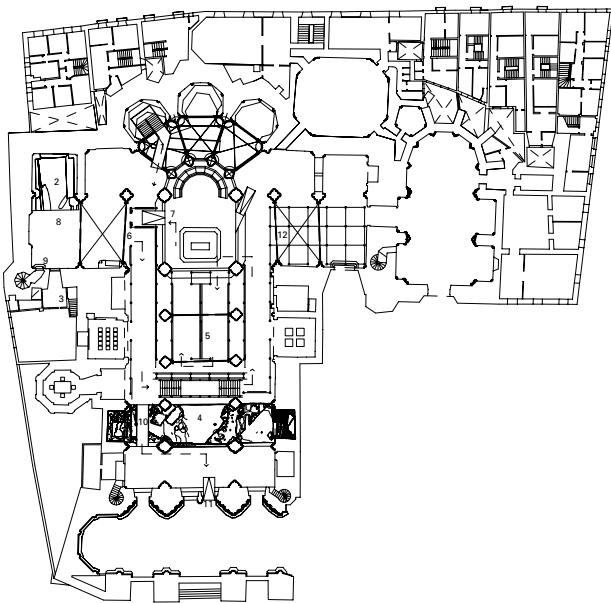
Propuesta de exposición temporal. Nivel planta baja
